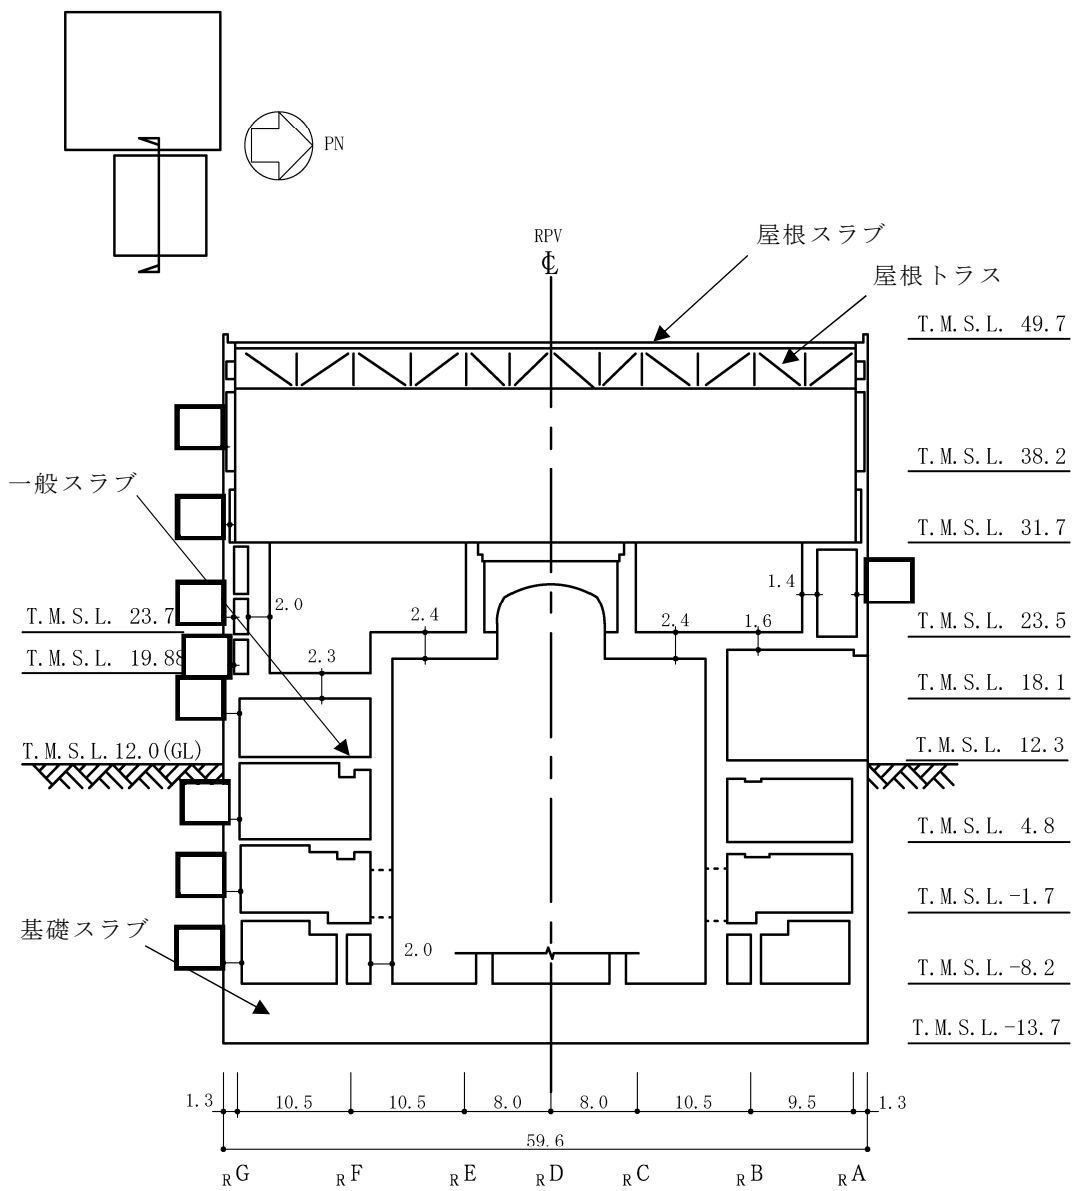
原子炉建屋の概略断面図 (EW方向) (単位 : m) (2/2)
